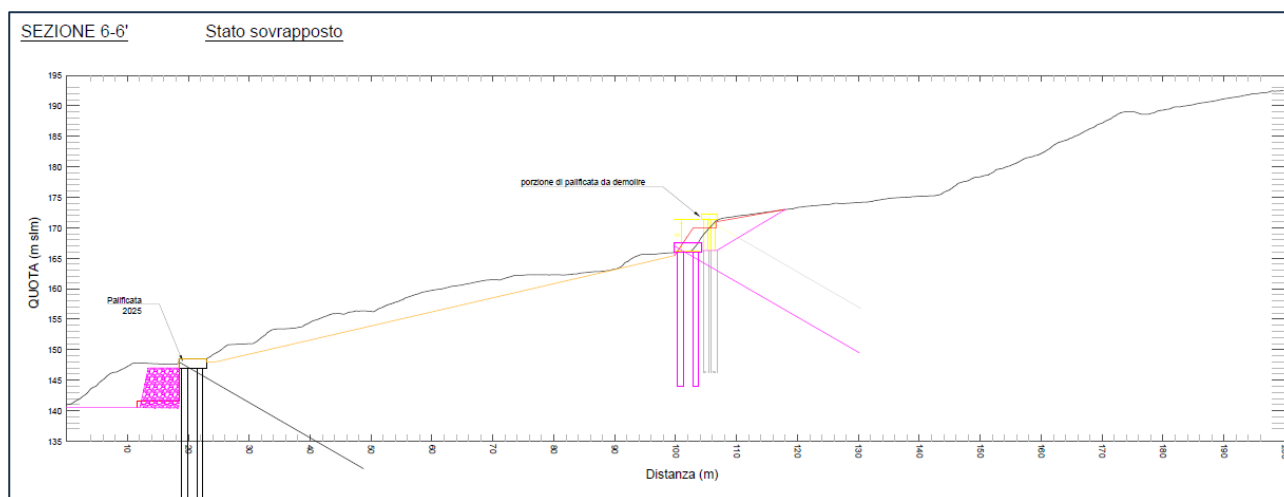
sezione 6-6' stato sovrapposto (in magenta le modifiche rispetto allo stato autorizzato)
